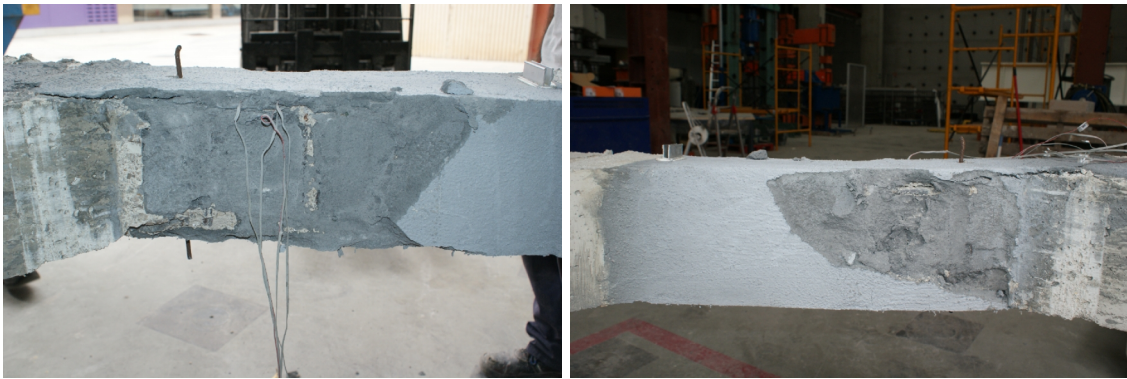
Pilares PR4C_R4+PU tras el ensayo a compresión. Detalle del desprendimiento de la capa de reparación de las caras laterales tras el ensayo.
